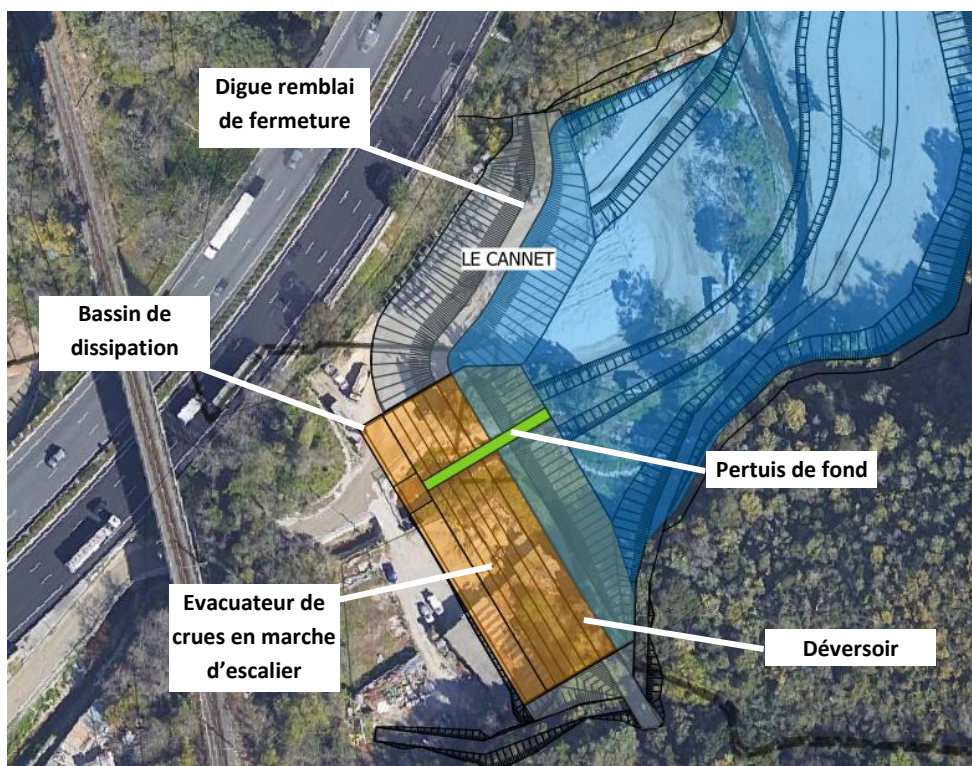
Détail de l'aménagement hydraulique de Carimai – lignes de structures issues du plan AVP (Fond de plan Google Satellite 2023A)
